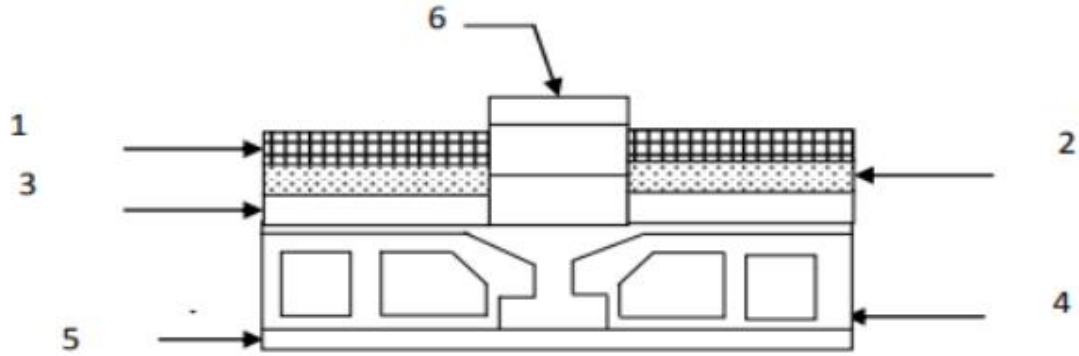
Les éléments qui constituent un plancher corps creux.
